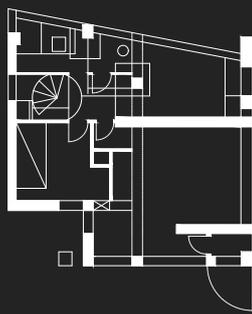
| Planta do piso térreo da E.1027 - produção própria.
